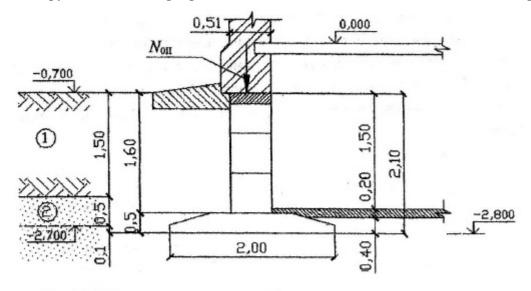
Конструкция ленточного фундамента, строение основания: 1 — насыпной слой, 2 — пылеватый песок
